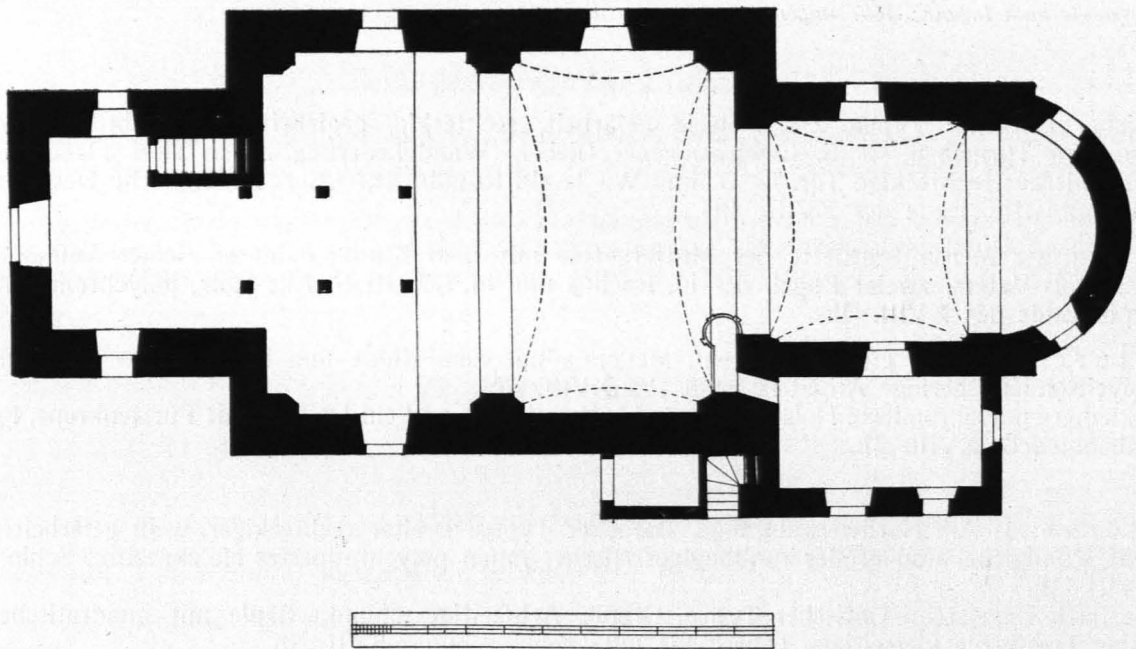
Wurmbrand, Pfarrkirche, Grundriß 1 : 200 (S. 294)
